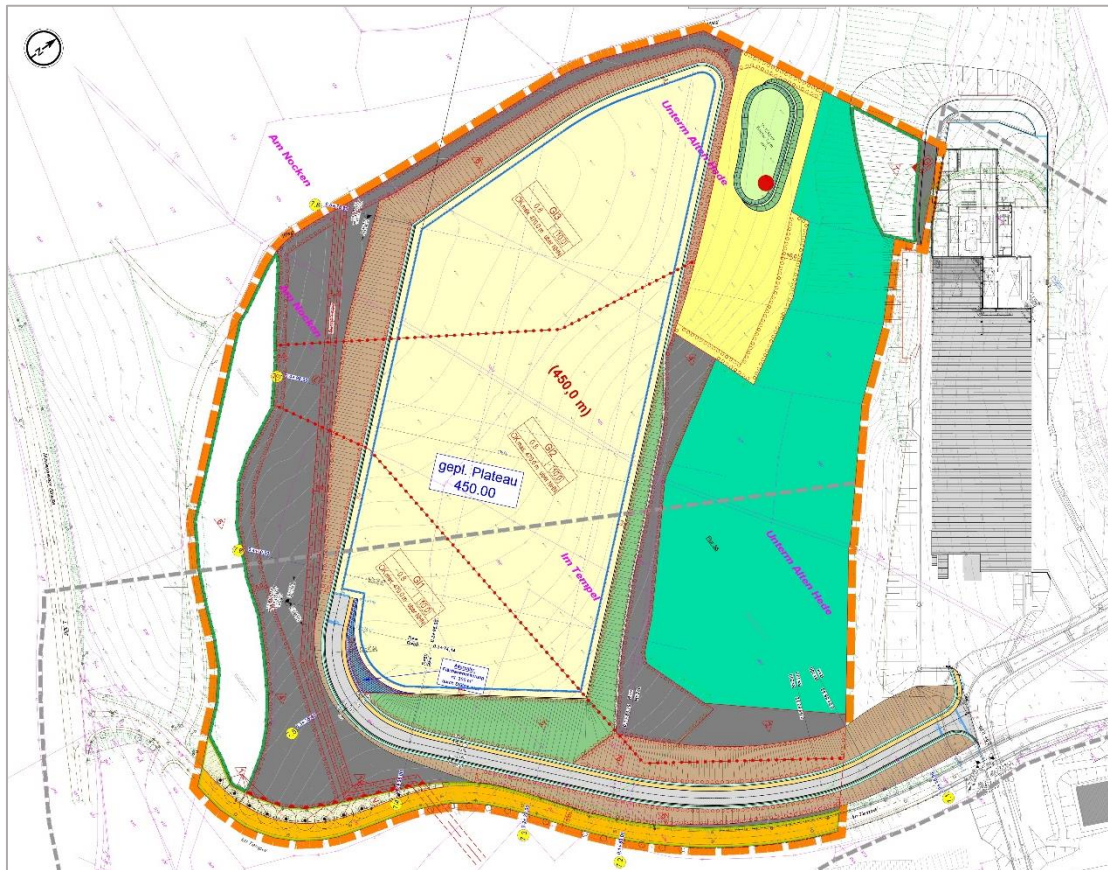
Vorplanung Erschließung Bebauungsplan „Woeste II“ – Stand: 25.12.2022 (Quelle: Bramey Bünermann Ingenieure, Dortmund)
